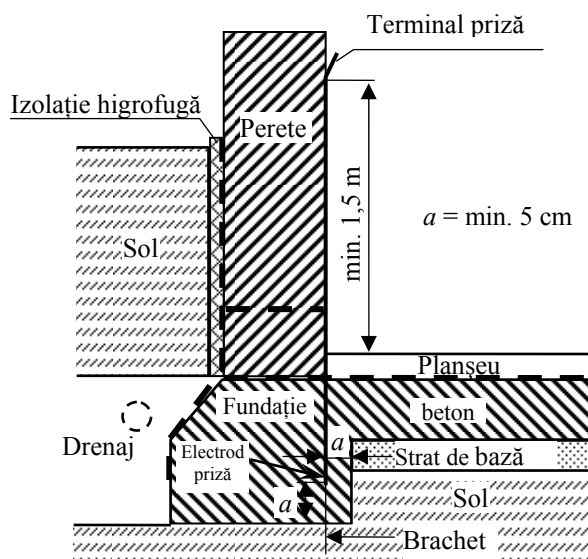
Schiță privind plasarea prizei de pământ în fundația fără armătură
